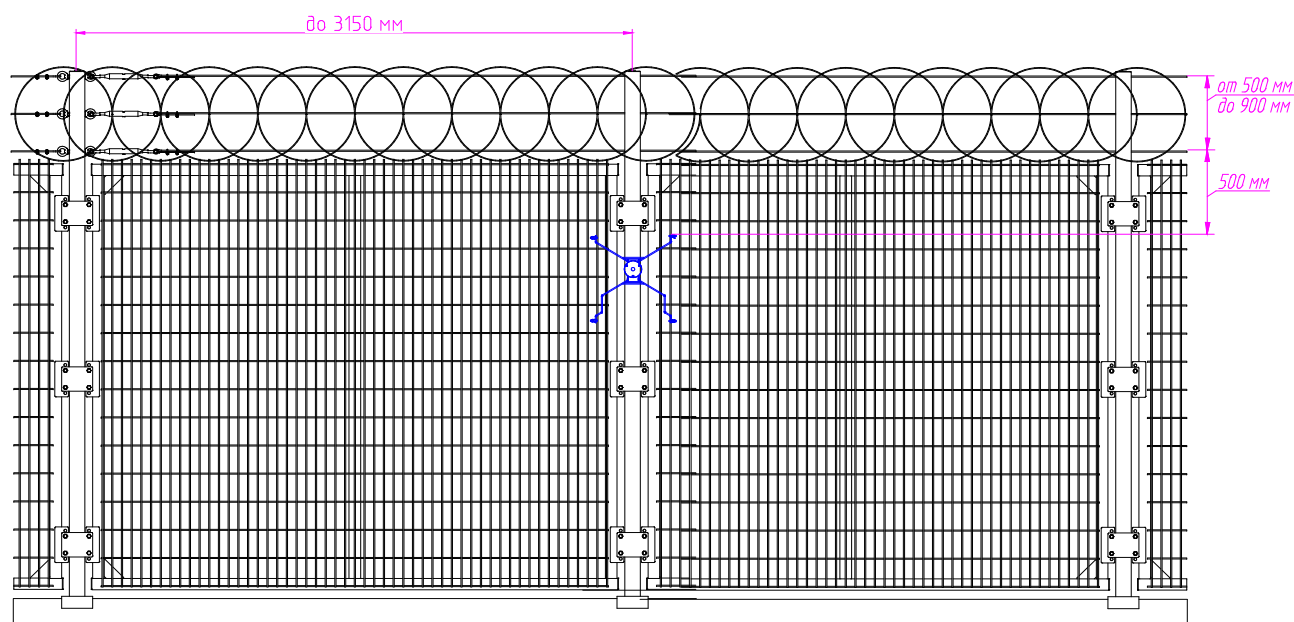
Установка датчика ДВ-А на соединитель секций
